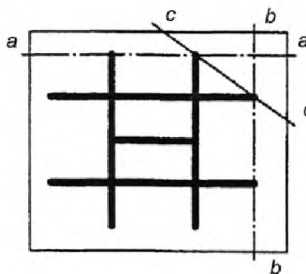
Стальные листы для крепления с армированием
